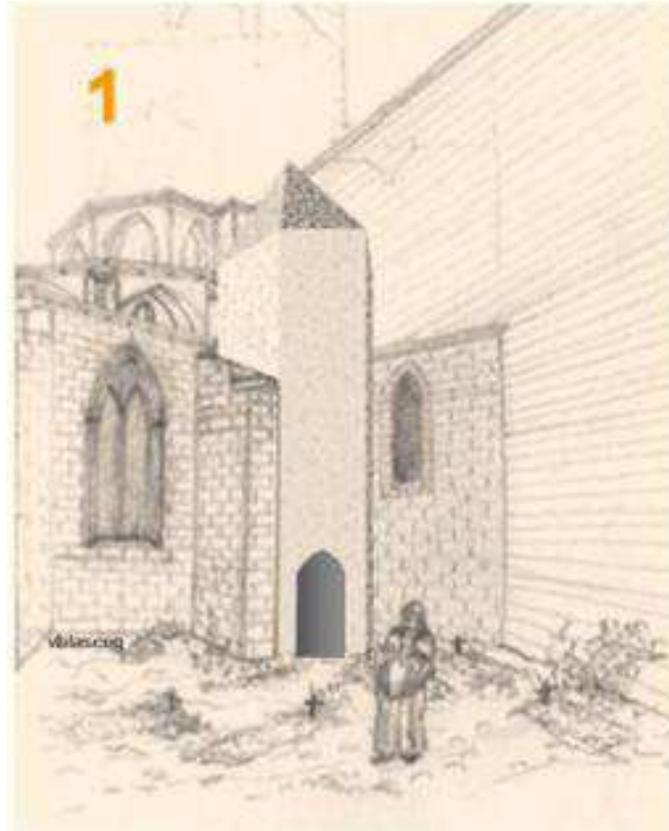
12.1 Croquis de figuración hipotética de la escalera exterior entre los muros de las antiguas capillas de St Antoni y St Nicolau. <sup>293</sup>
